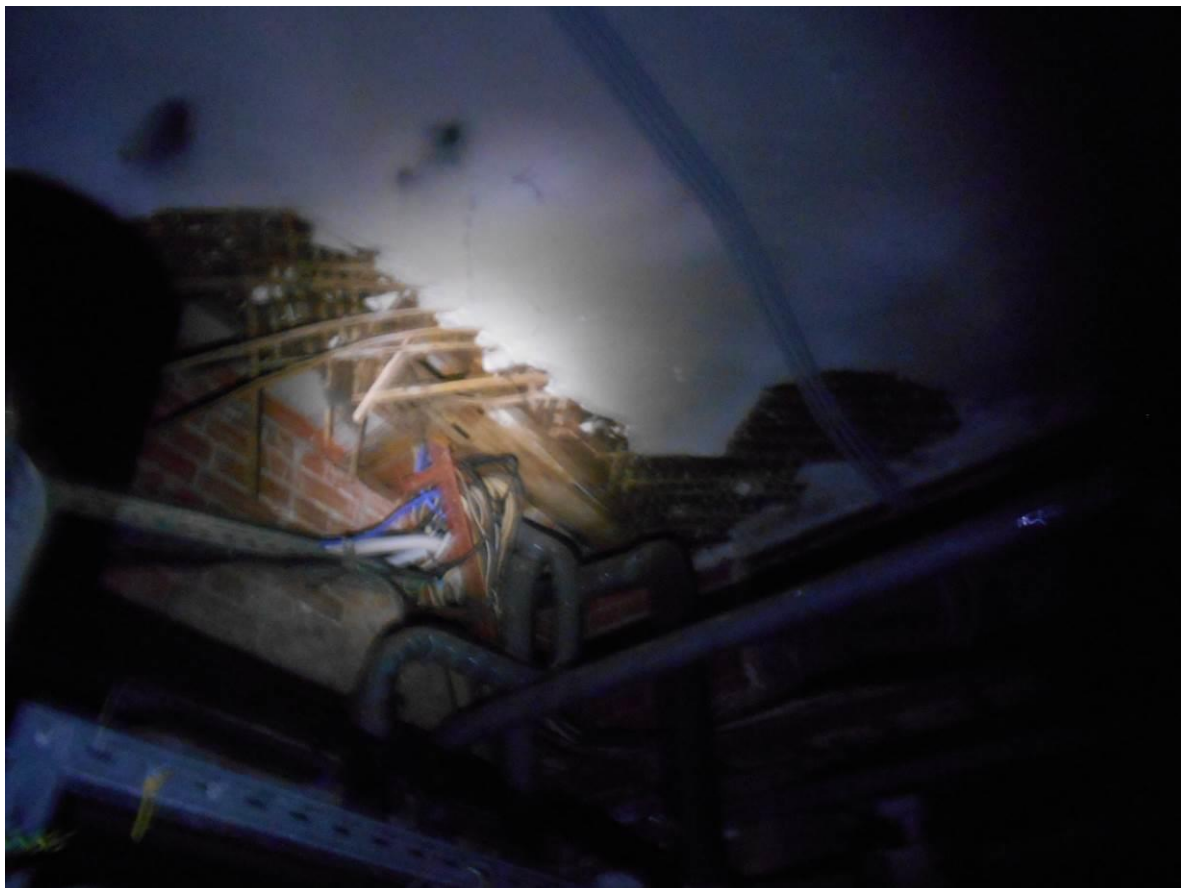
Перекрытие подвала в осях 3-4/Г-Е. Гниение и разрушение деревянного перекрытия. Следы протечек инженерных коммуникаций
